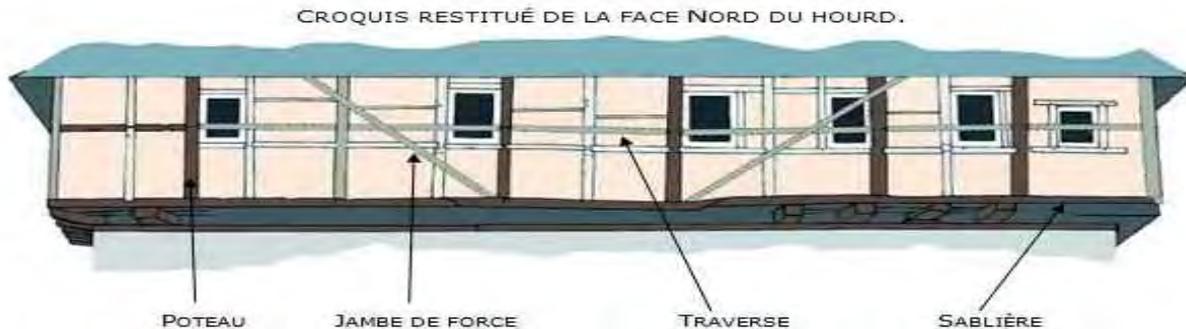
Croquis de la façade Nord de la superstructure et du hourd. © J.-L. JAVAUX 2008.
